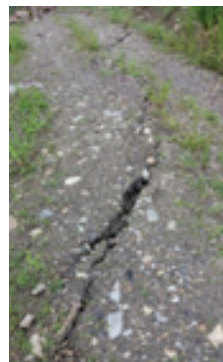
Grieta de tracción hallada en media ladera de la Zona Núm 4
